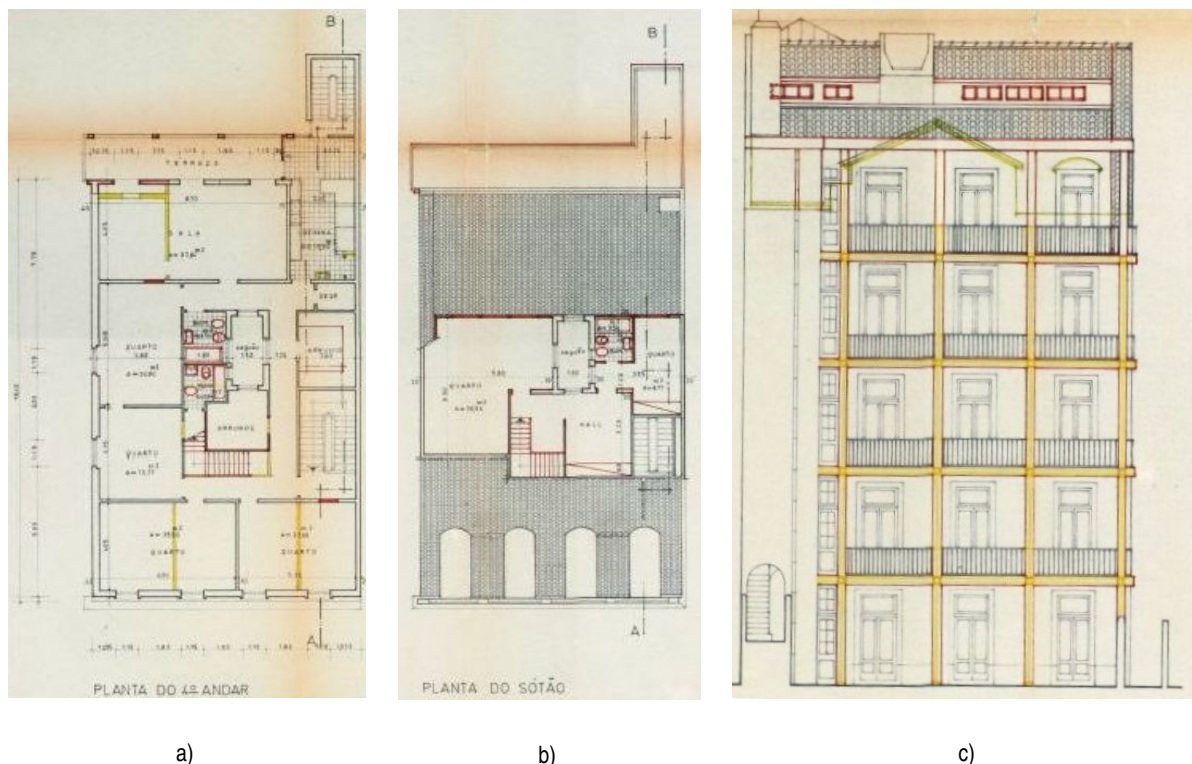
Alterações em 1992: a) plantas do 4º piso; b) planta do sótão; c) pórticos de betão armado no tardo (Arquivo Municipal de Lisboa, 2012)
